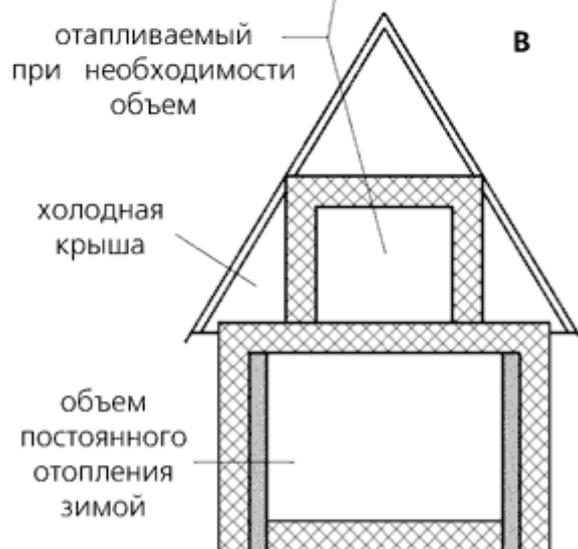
Схемы утепления разных конструкций корпуса экодома.
